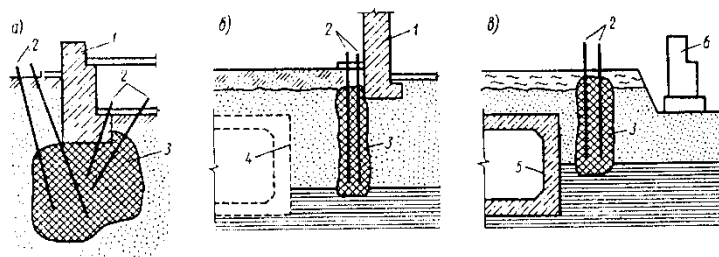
Схема закрепления методом силикатизации оснований фундаментов (а), защиты фундаментов зданий при строительстве подземных сооружений (б) ,при возведении зданий (в):
